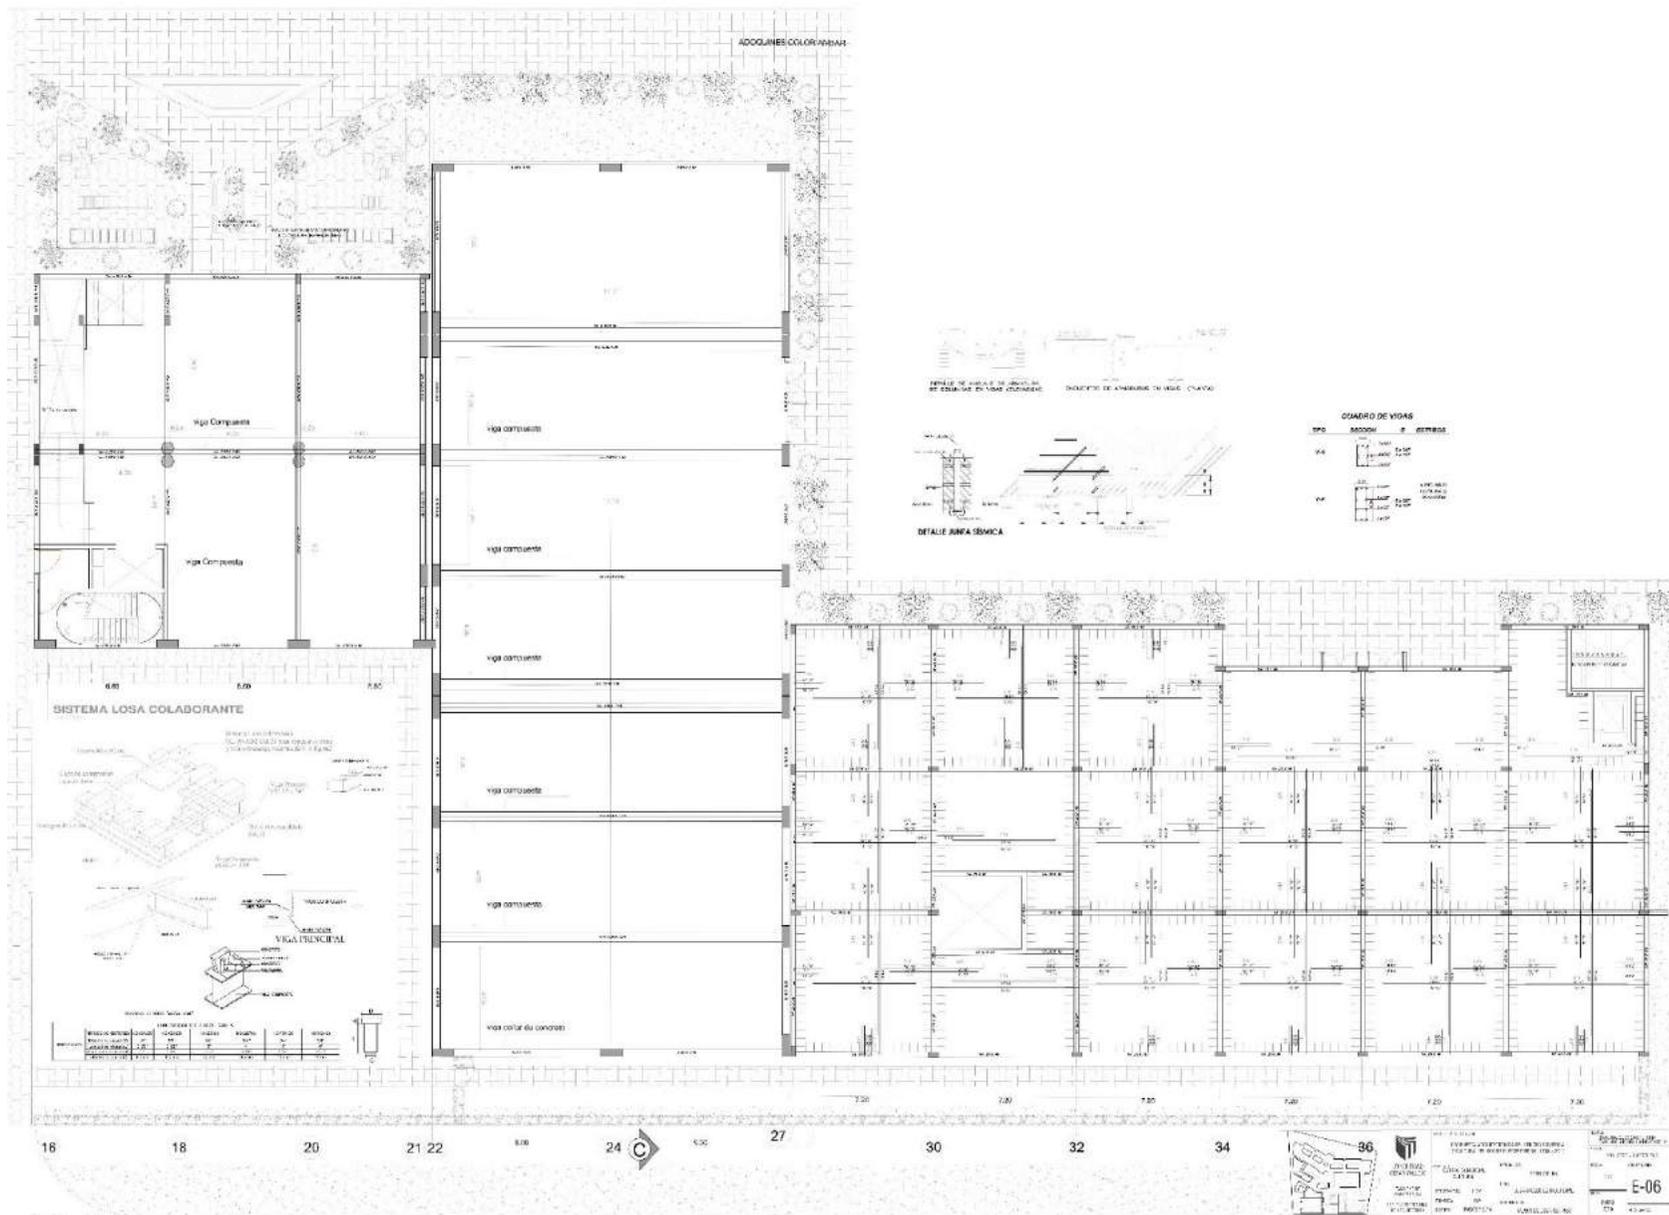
Plano E. aligerado – zona cultural. Elaboración propia.
